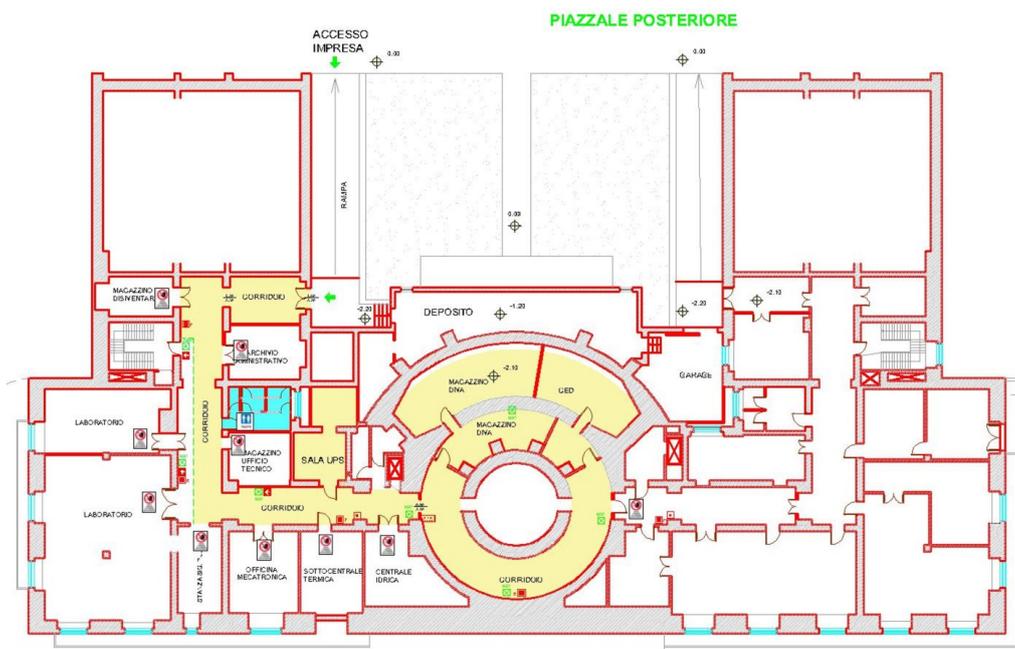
Aree di transito, di immagazzinamento e di cantiere.
